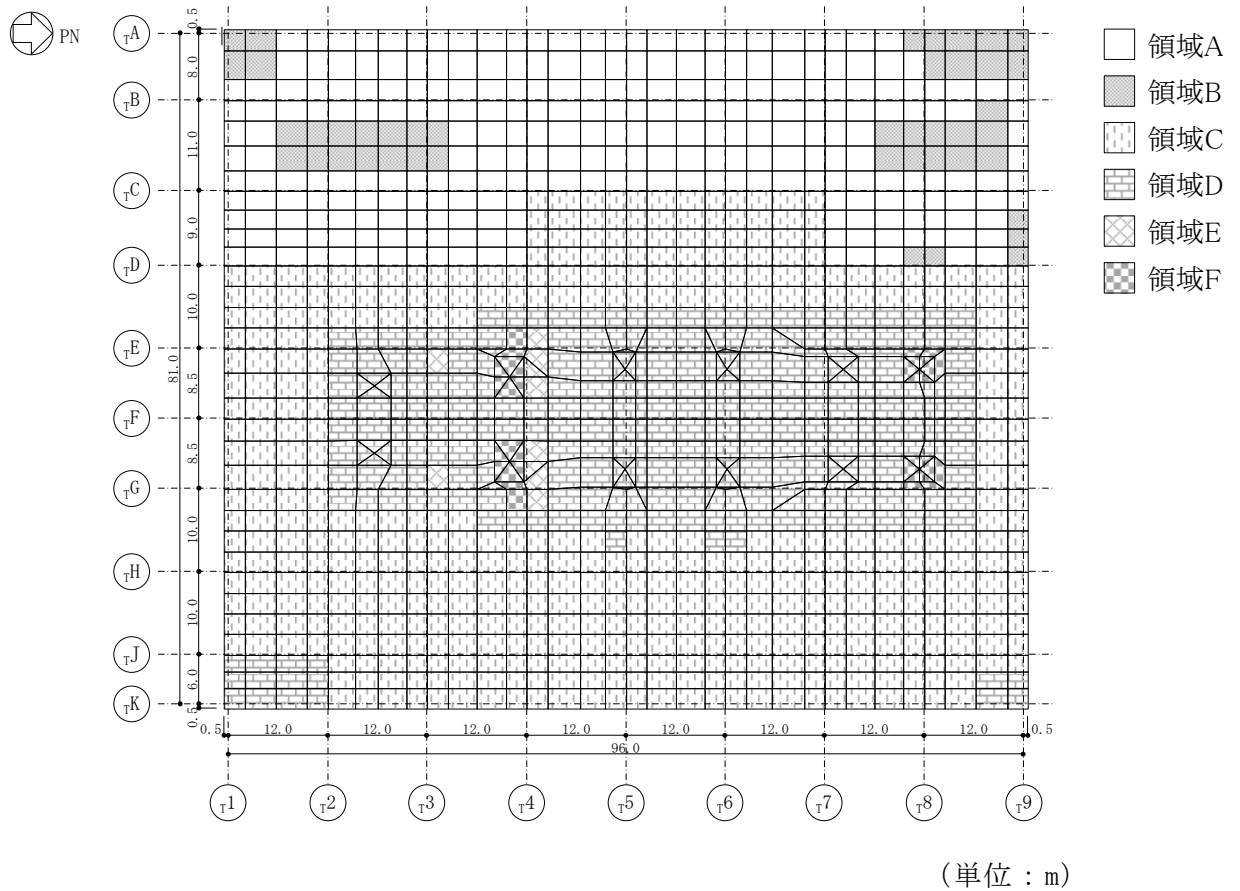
基礎スラブの配筋領域図 (EW 方向, 上ば筋)
